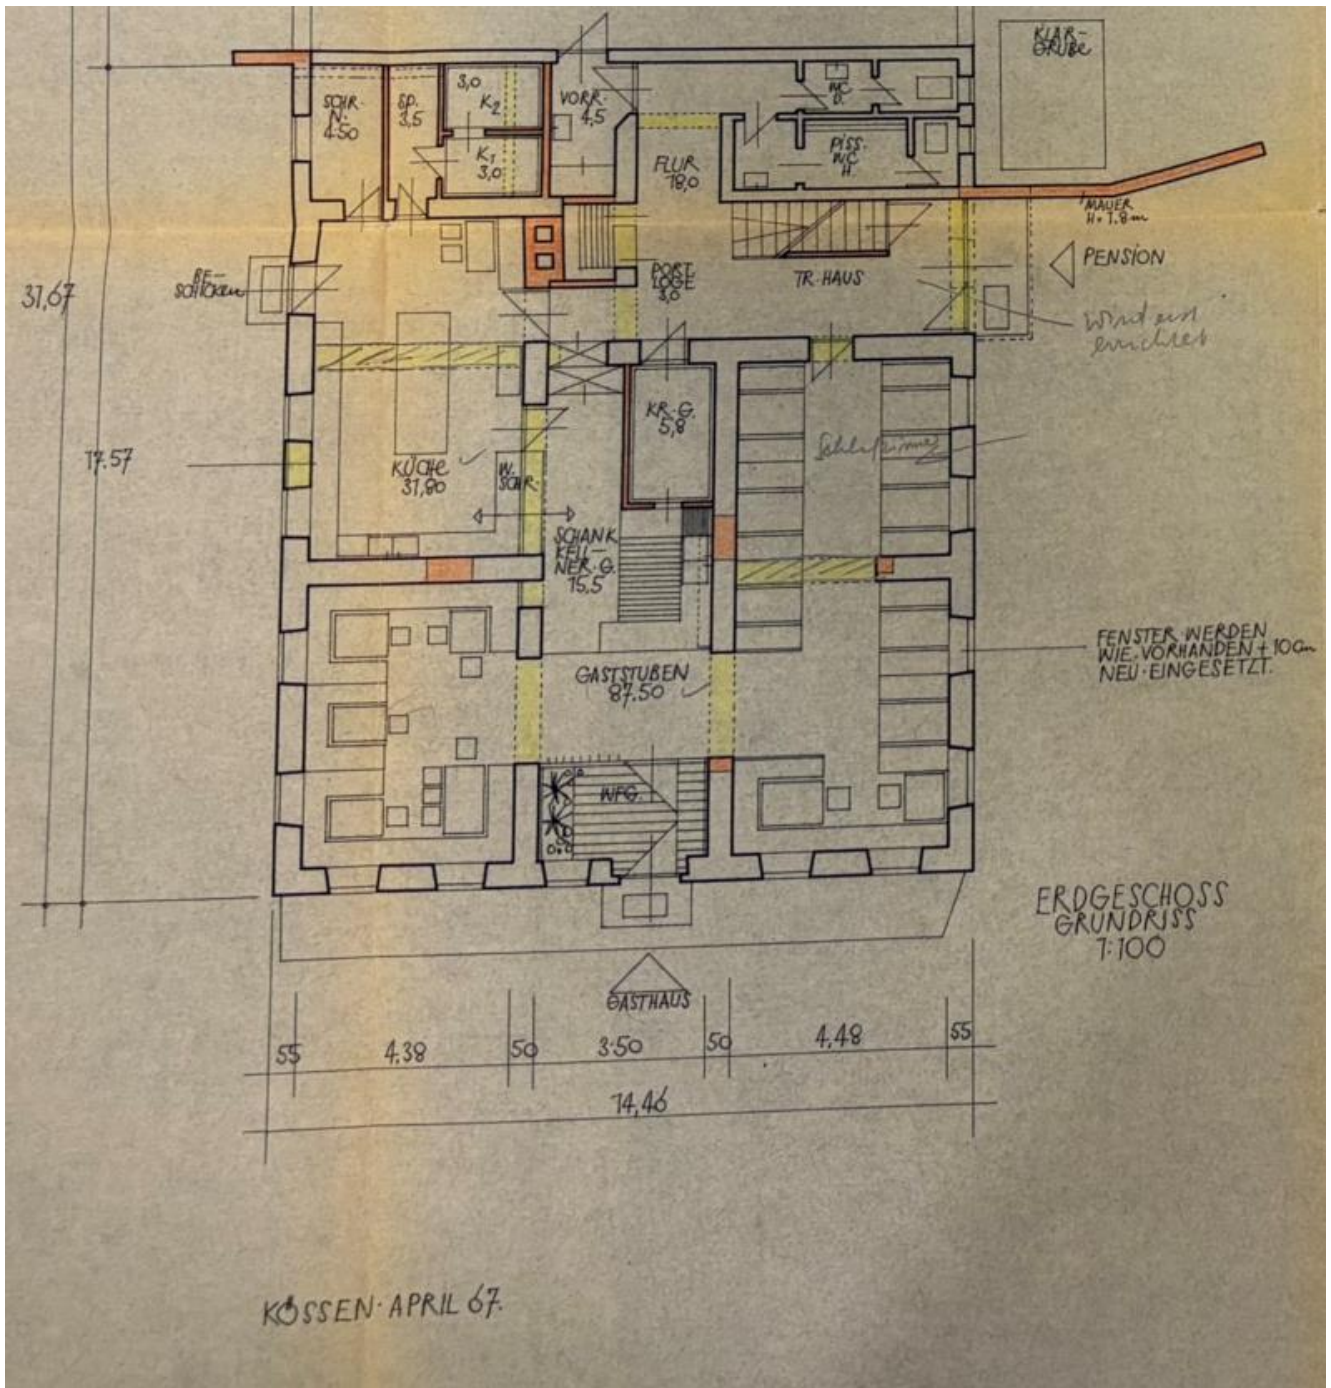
Grundriss Erdgeschoss (1967)
